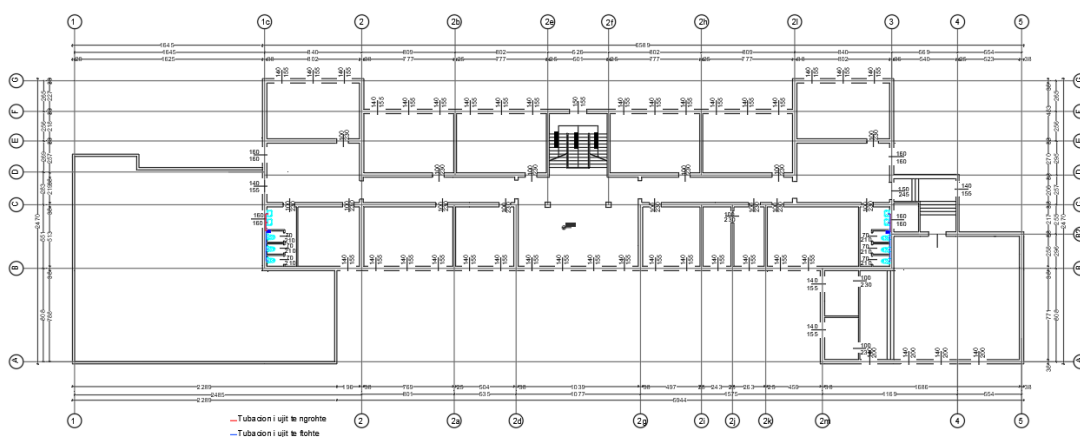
Planimetria e instalimeve hidraulike, kati i pare
